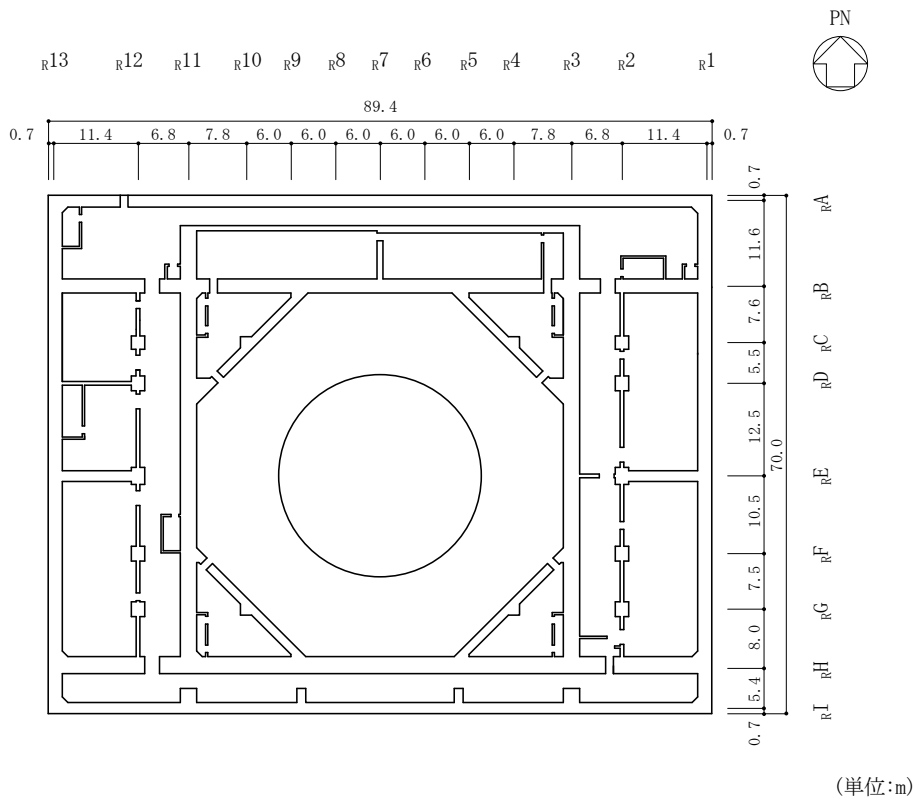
(1) 原子炉建物の概略平面図 (EL 1.3m*)
